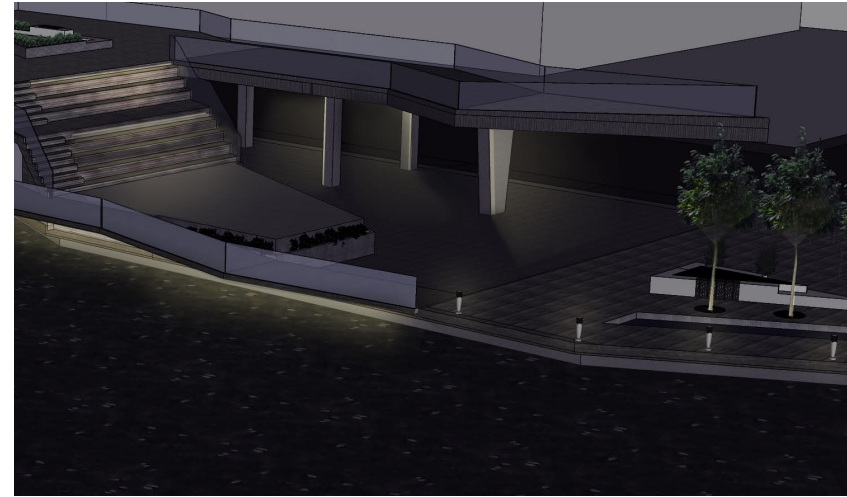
Iluminación. Fuente: (Elaboración propia).
